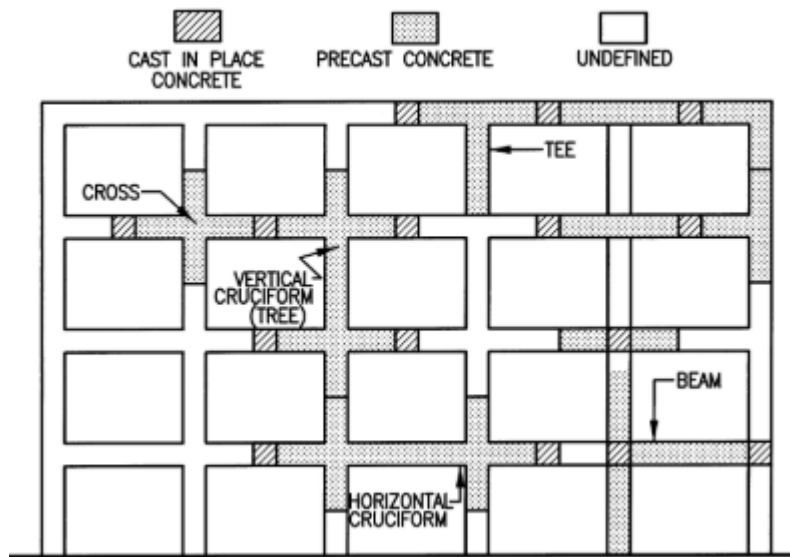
Configuraciones de pórticos con elementos prefabricados.
